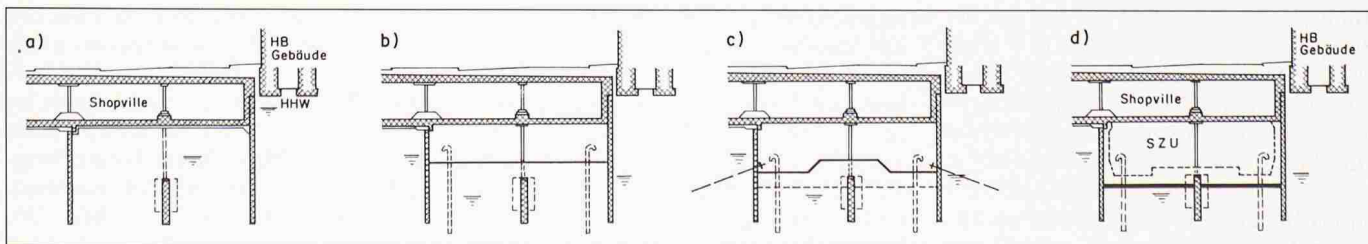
Querschnitte mit Bauvorgang unter bestehendem Shopville: a) Vorsorgliche Massnahmen für U-Bahn. Grundwasserabsenkung aus Baugrube Habis-Royal; b) Voraushub. Wasserspiegelabsenkung mit KleinfILTERBRUNNEN; c) Etappenweiser Aushub und Einbau der Anker; d) Etappenweiser Endaushub und Einbau Stahlbetonplatte («Horizontalspriess»)
